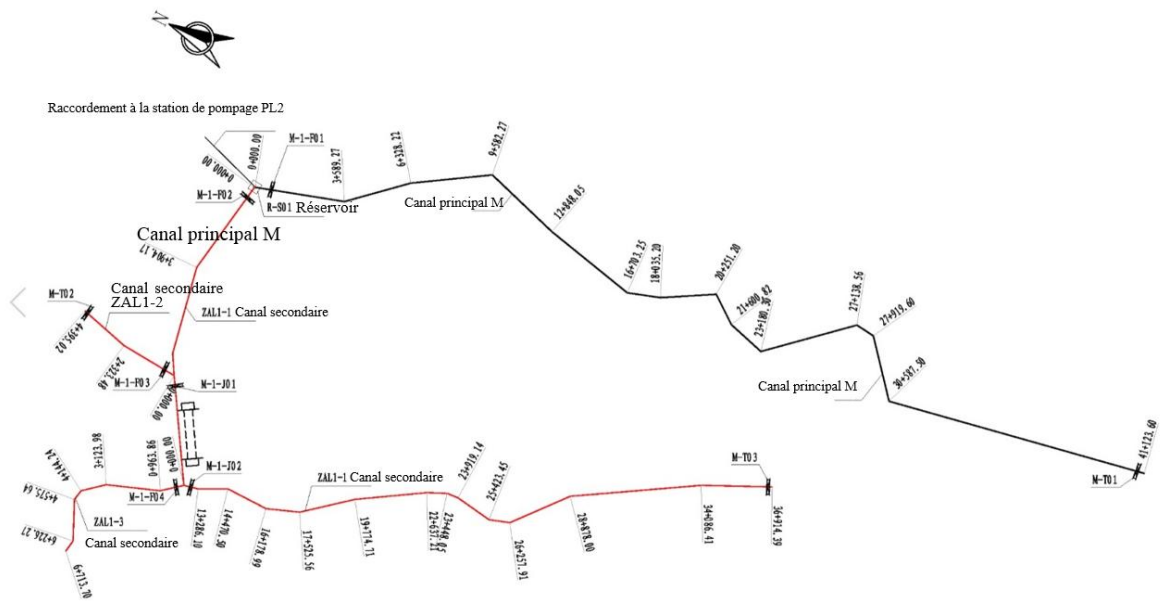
Plan d'aménagement des canaux principaux et secondaires de l'ouest II
